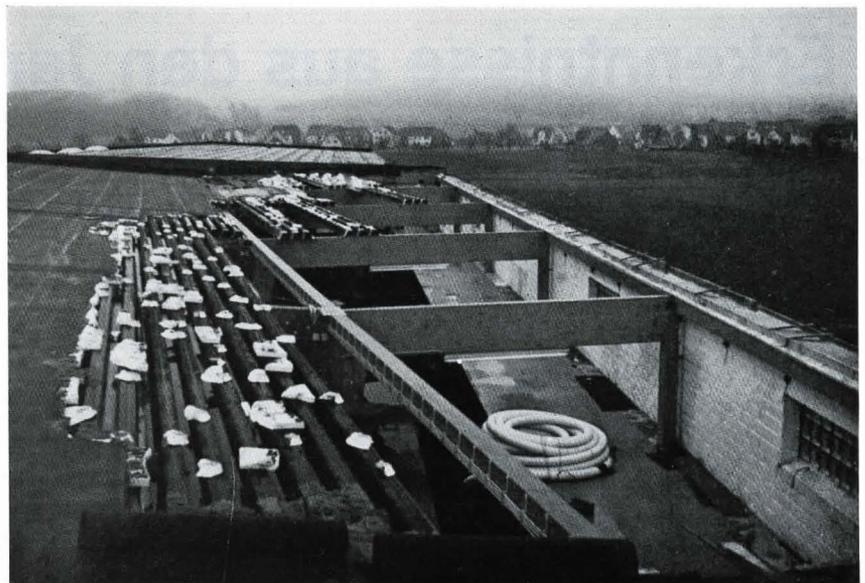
Nicht fachgerechte Verklebung der Isolierung auf einem Trapezblechdach.
